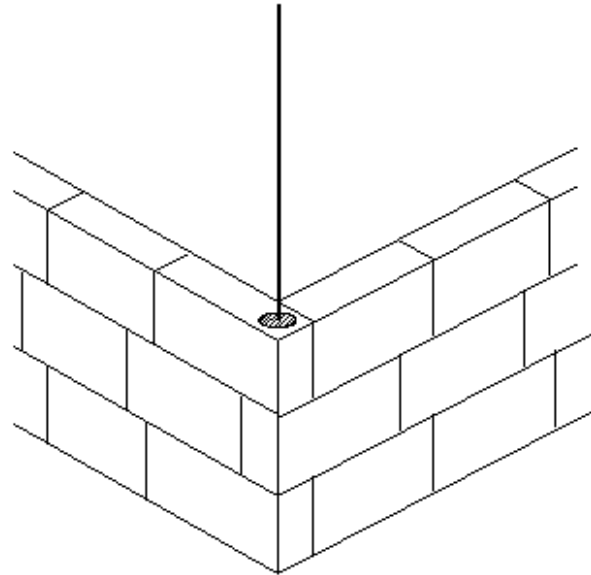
Se va levantando mampostería enhebrando los bloques O en las esquinas.
